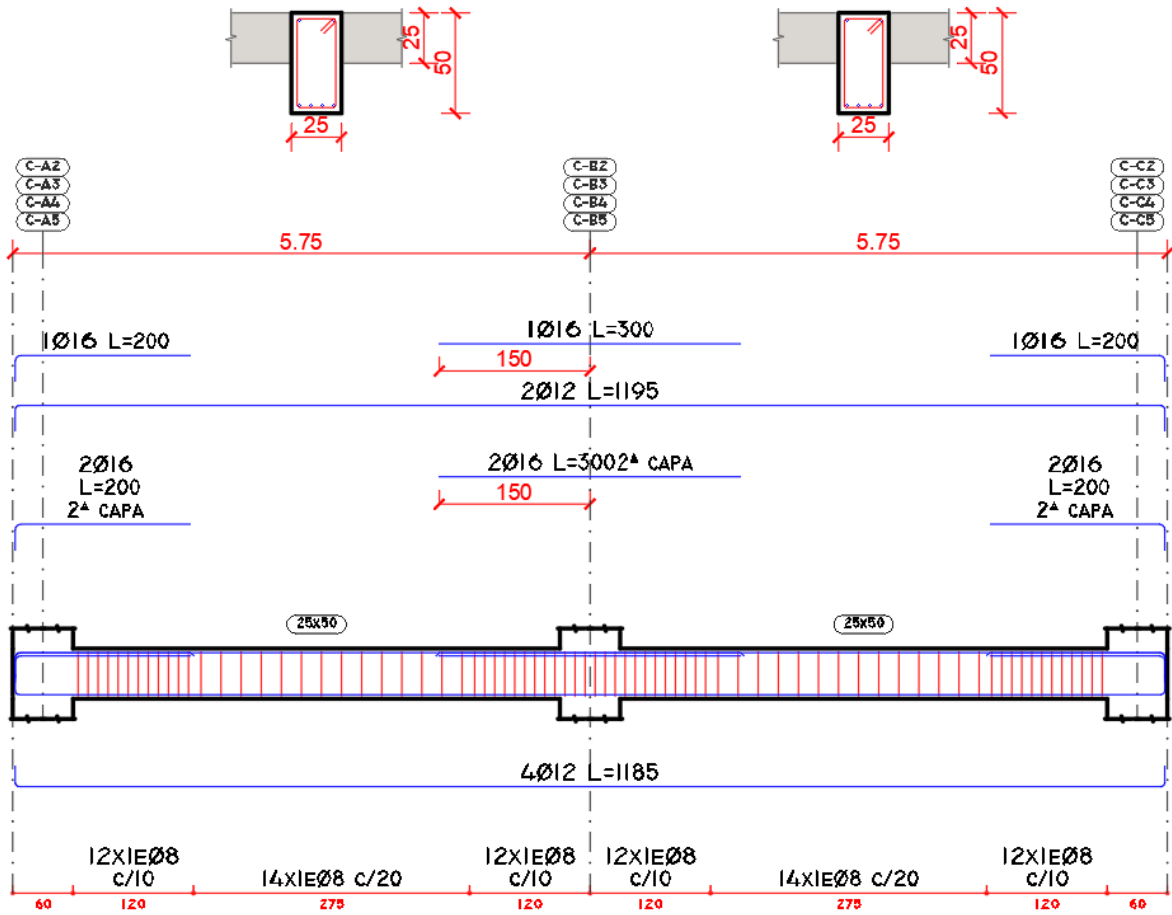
Detalle de Refuerzo Vigas en "X" Losa 5 a 7 Estructura [7N-EE].
